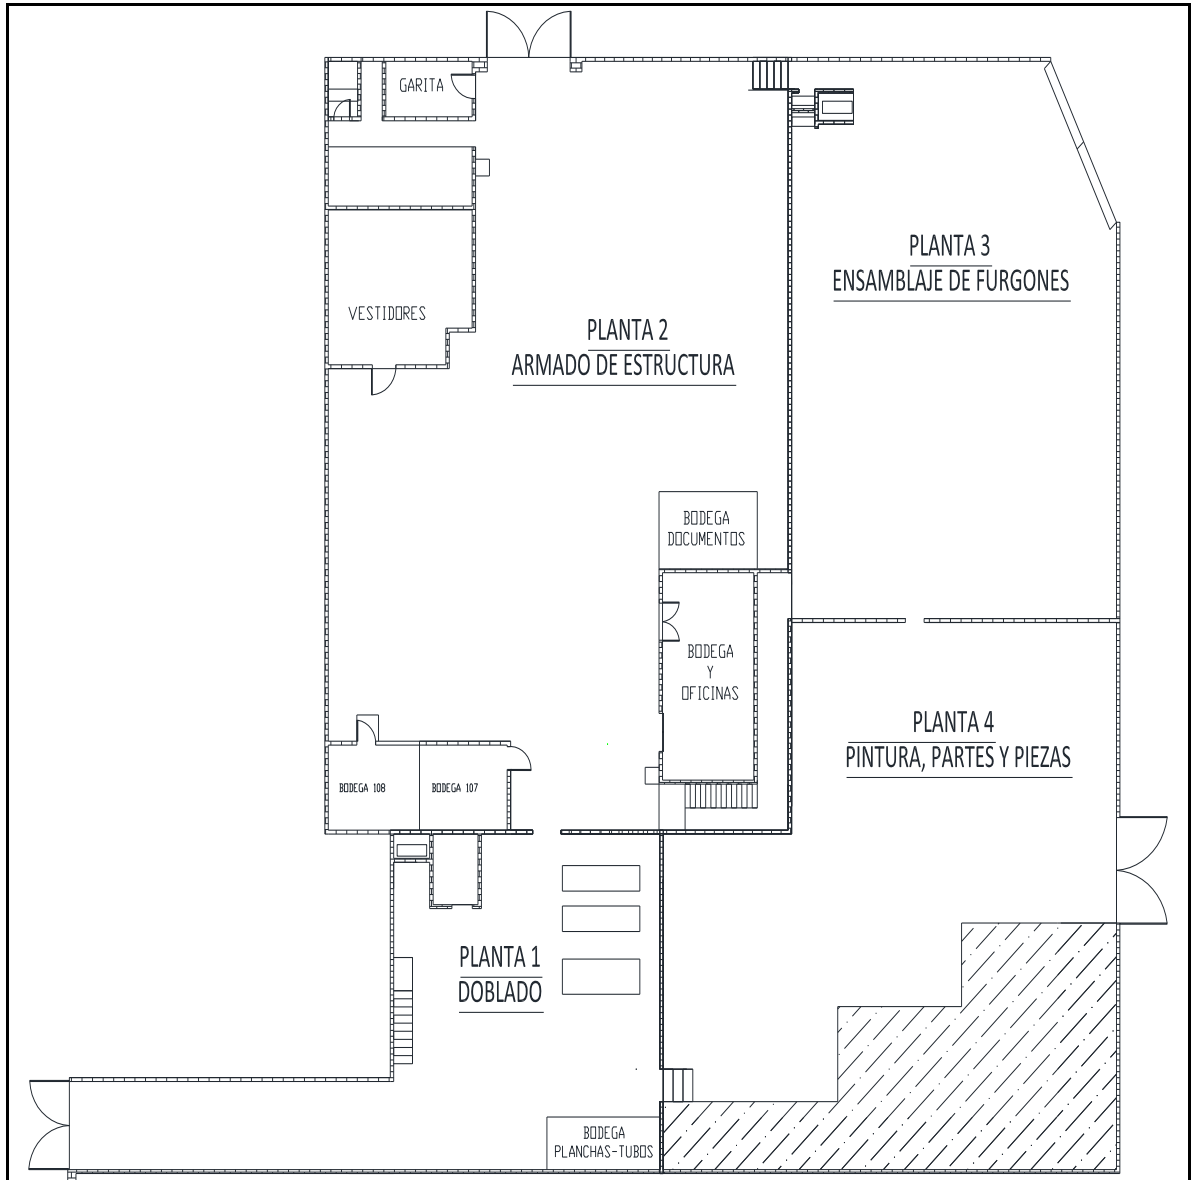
Distribución de planta CEPSAN Carrocerías Especiales
